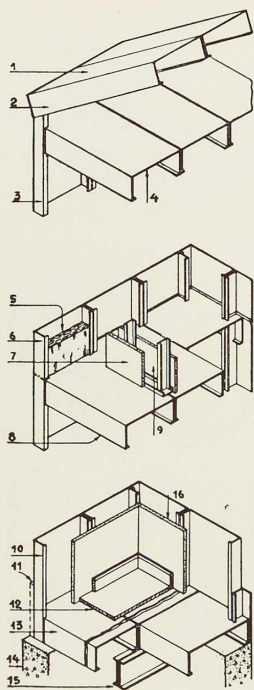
LÉGENDE. 1. Revêtement de toiture quelconque. 2. Élément de toiture en tôle pliée. 3. Élément de mur en tôle pliée. 4. Élément de plancher en tôle pliée. 5. Panneau isolant. 6. Cornière de support. 7. Revêtement extérieur quelconque. 8. Élément de plancher en tôle pliée. 9. Ossature standard de cloison intérieure. 10. Élément de mur en tôle pliée. 11. Revêtement extérieur. 12. Revêtement de plancher quelconque. 13. Élément de plancher en tôle pliée. 14. Béton. 15. Solive en acier. 16. Revêtement de mur quelconque.
